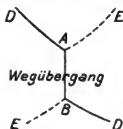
Darstellung der Massenlinie einer Bahnstrecke mit Wegübergang.
